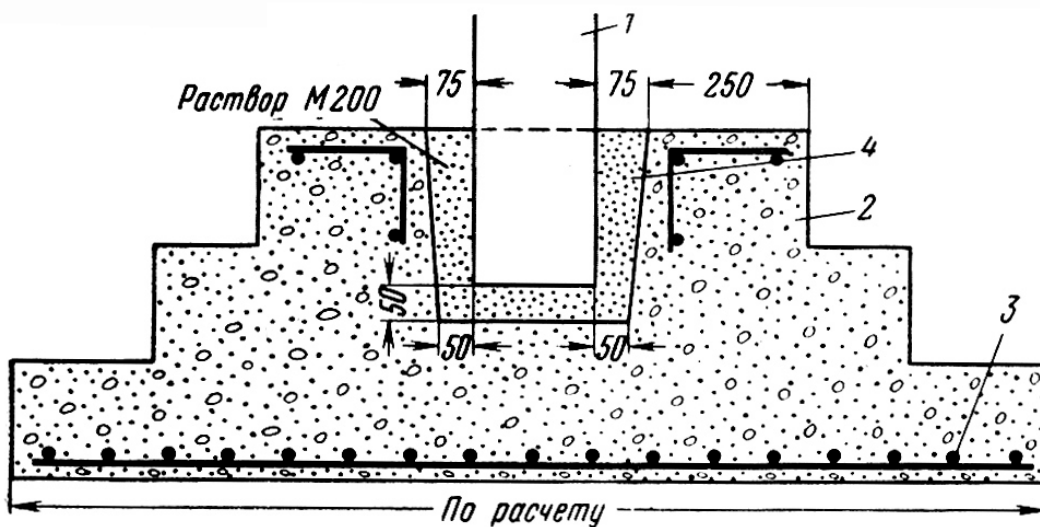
Сборный фундамент под колонну промышленного здания:
